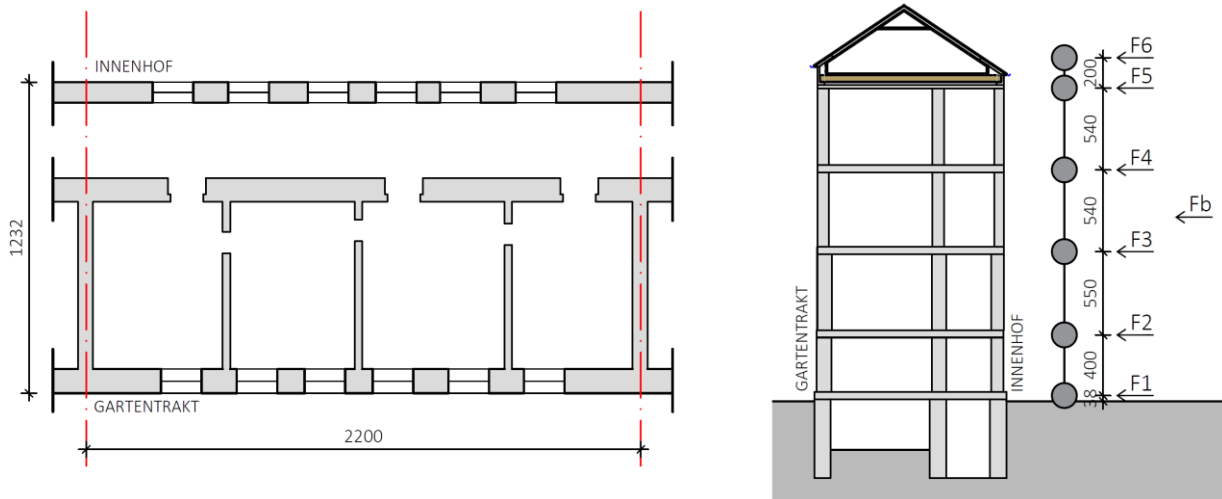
links Grundriss Massenermittlung, rechts Modell Massenverteilung
